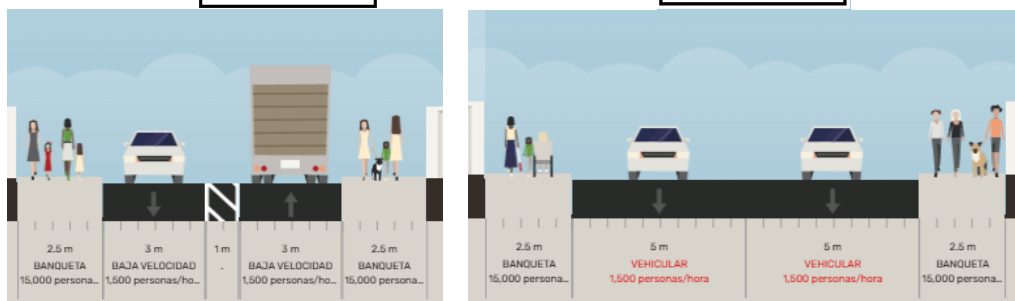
Secciones viales de Av. Imperio sección actual y propuesta. Fuente: PDU2040
